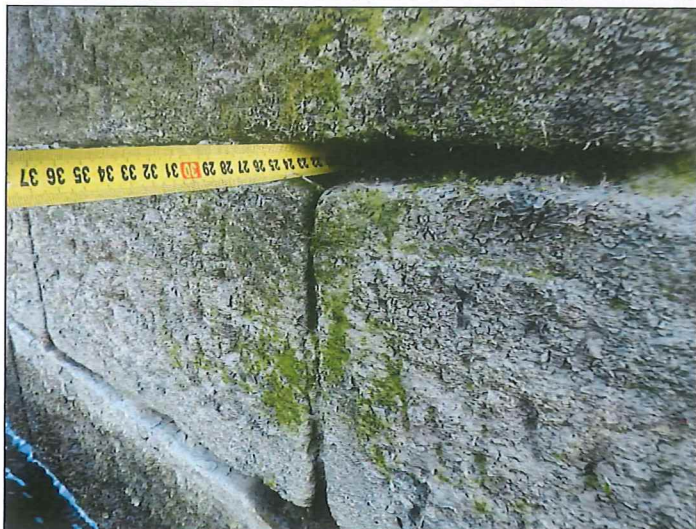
Pilíř P 04 z otvoru č. 4
